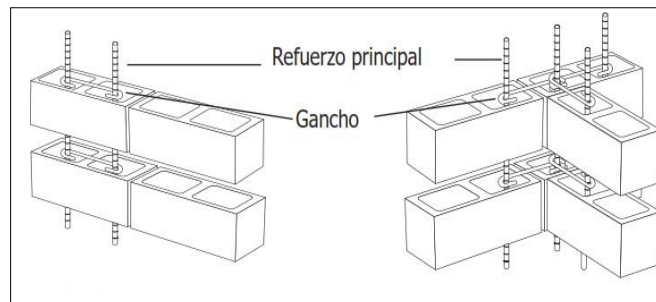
Albañilería armada. – Fuente: García J.²⁹
